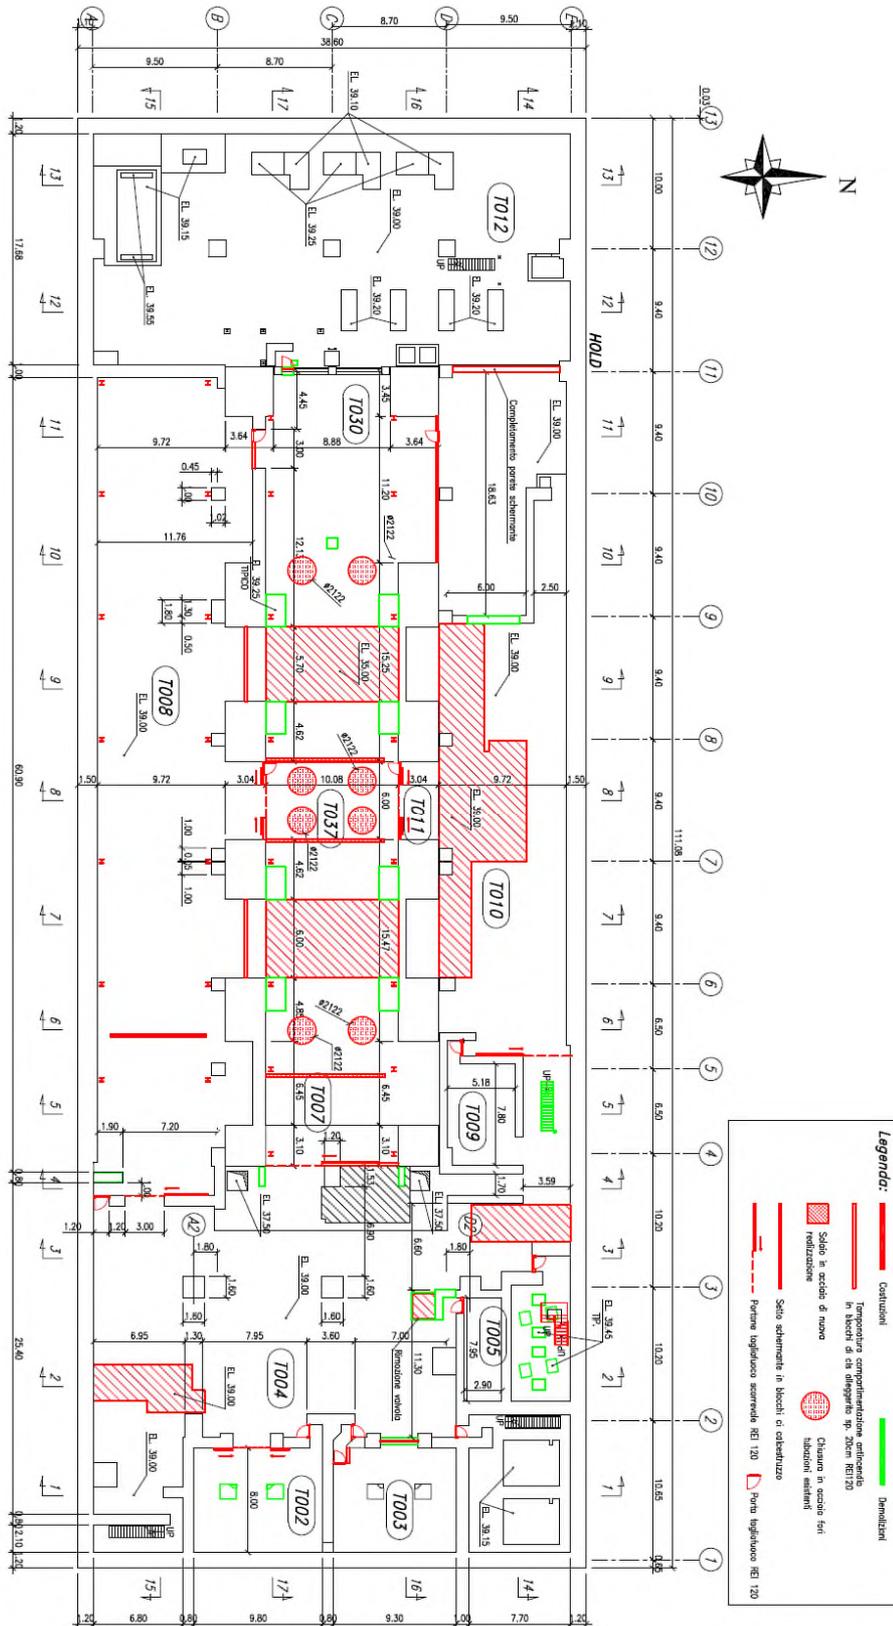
ET, pianta q 39m con demolizioni e ricostruzioni civili
